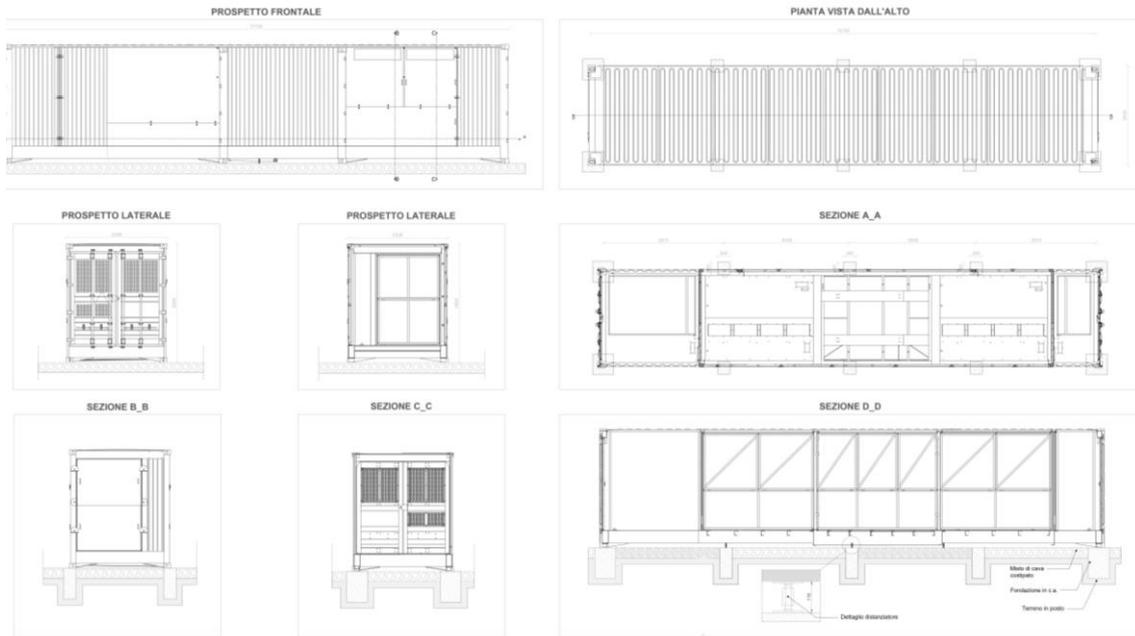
Particolare vista fondazioni tipo per posa Container Bess
